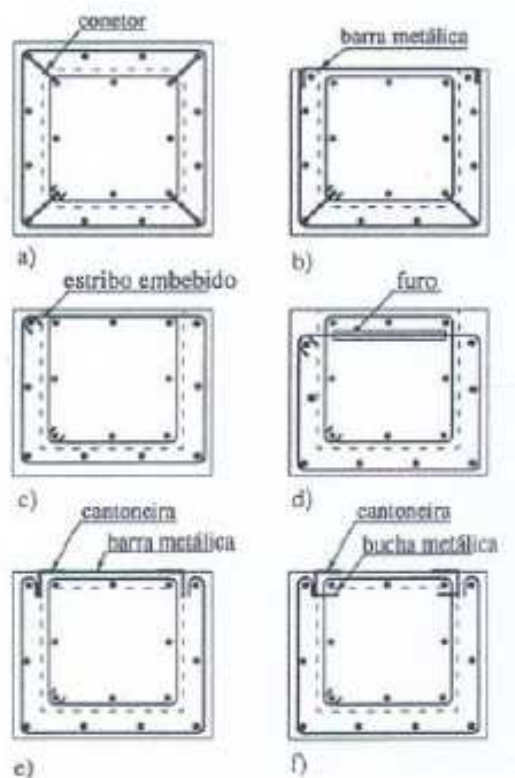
Disposição das armaduras mais utilizadas no encamisamento de pilares (Gomes, A., Appleton, J.)
